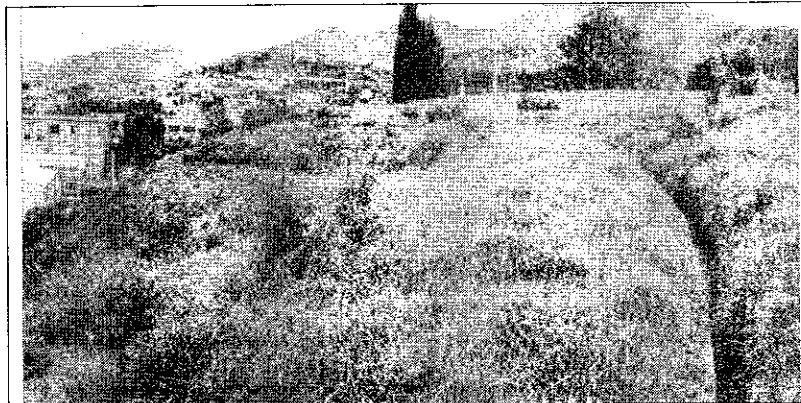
Evidencia de la existencia de la cuneta de sección rectangular, construida en concreto y ubicada en la parte alta de los taludes de corte presentes en el costado occidental del predio donde se encuentran emplazadas las estructuras que hacen parte del Conjunto Residencial "Villa Verde".
